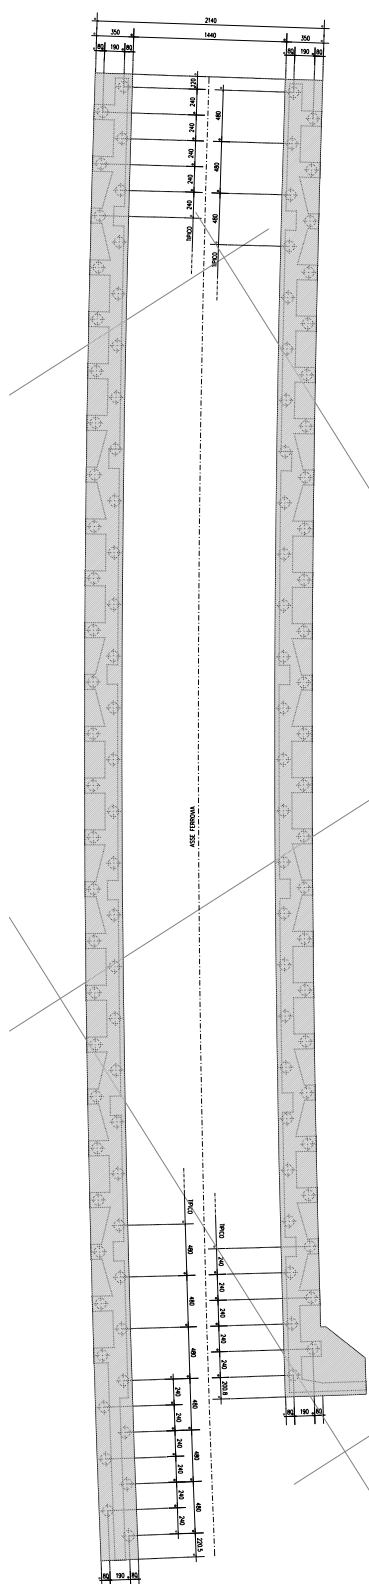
Pianta delle fondazioni della galleria ferroviaria.
